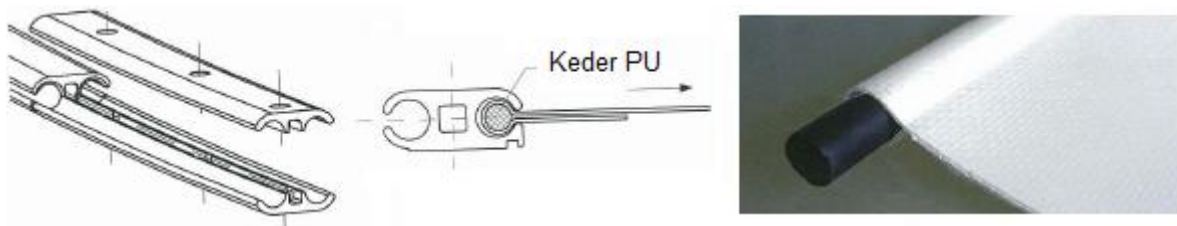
Pormenor de elemento rigidificador de membrana
